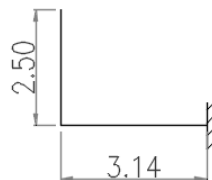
Esquema de dimensionamento da viga de estribo
